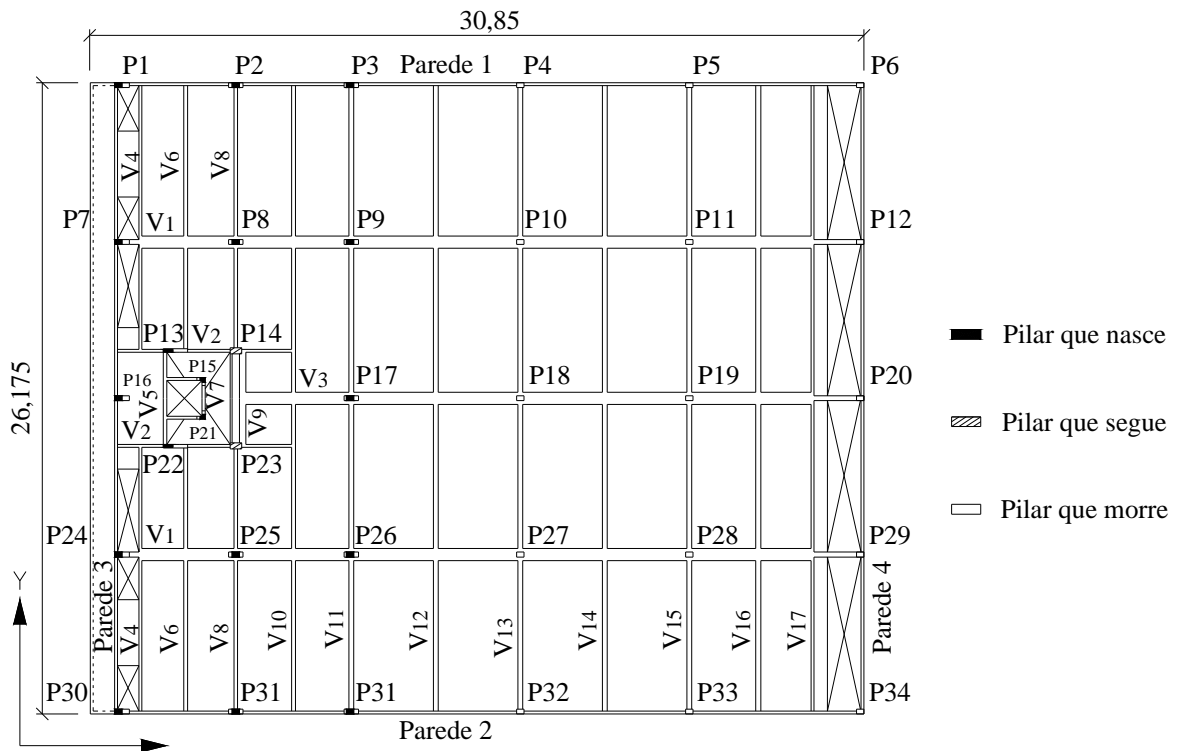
Estrutura do 1º pavimento (dimensões em metros).
